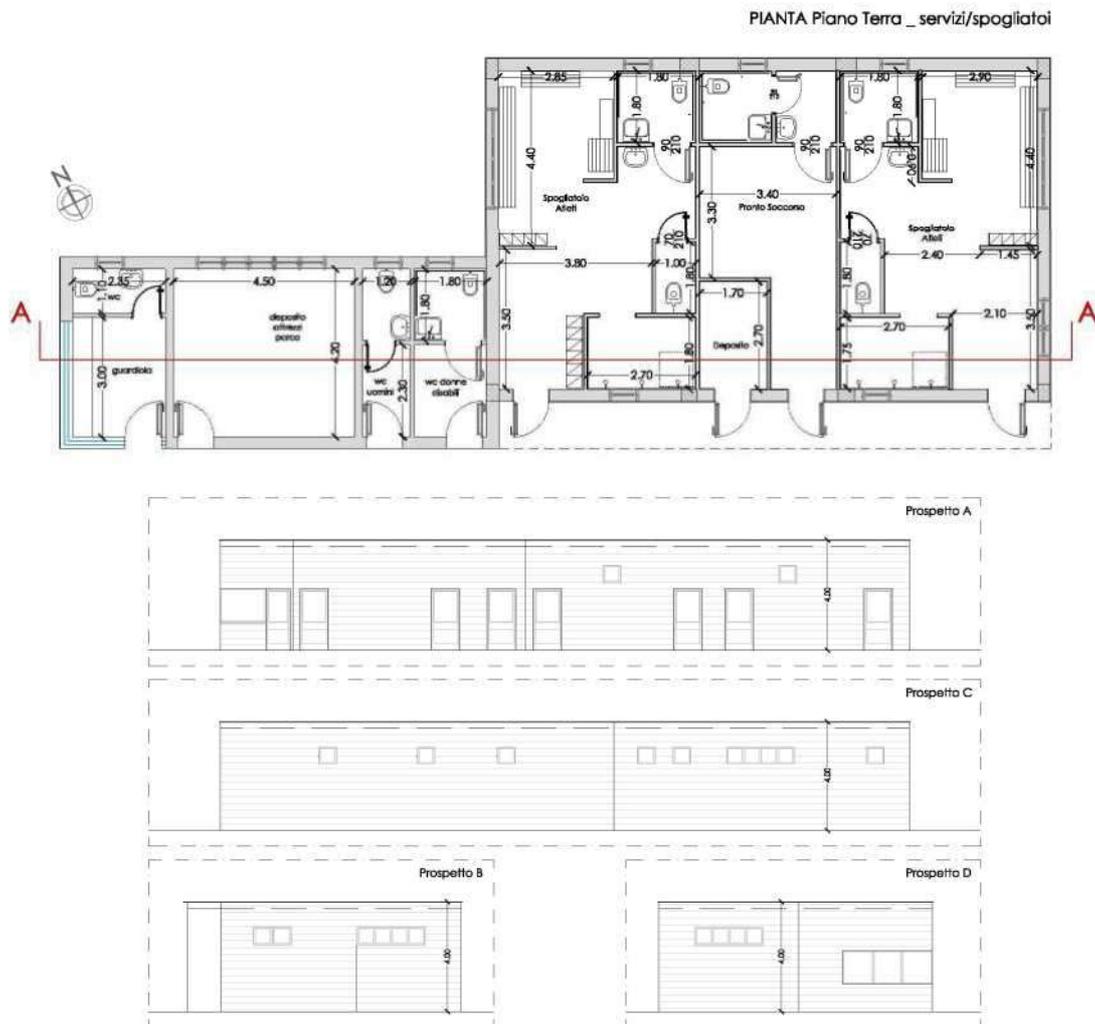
schema di progetto blocco spogliatoi-servizi \_ Pianta e Prospetti
